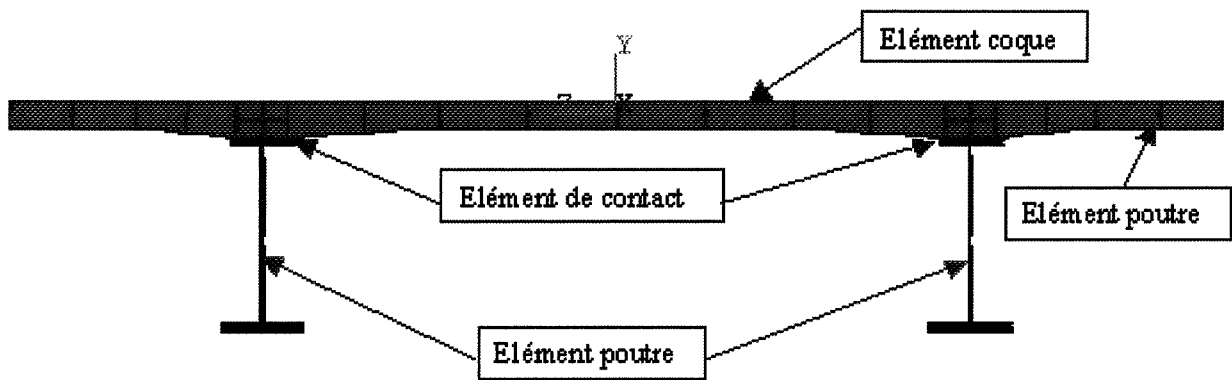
Elemente der Doppelträgerbrücke Typ TT
